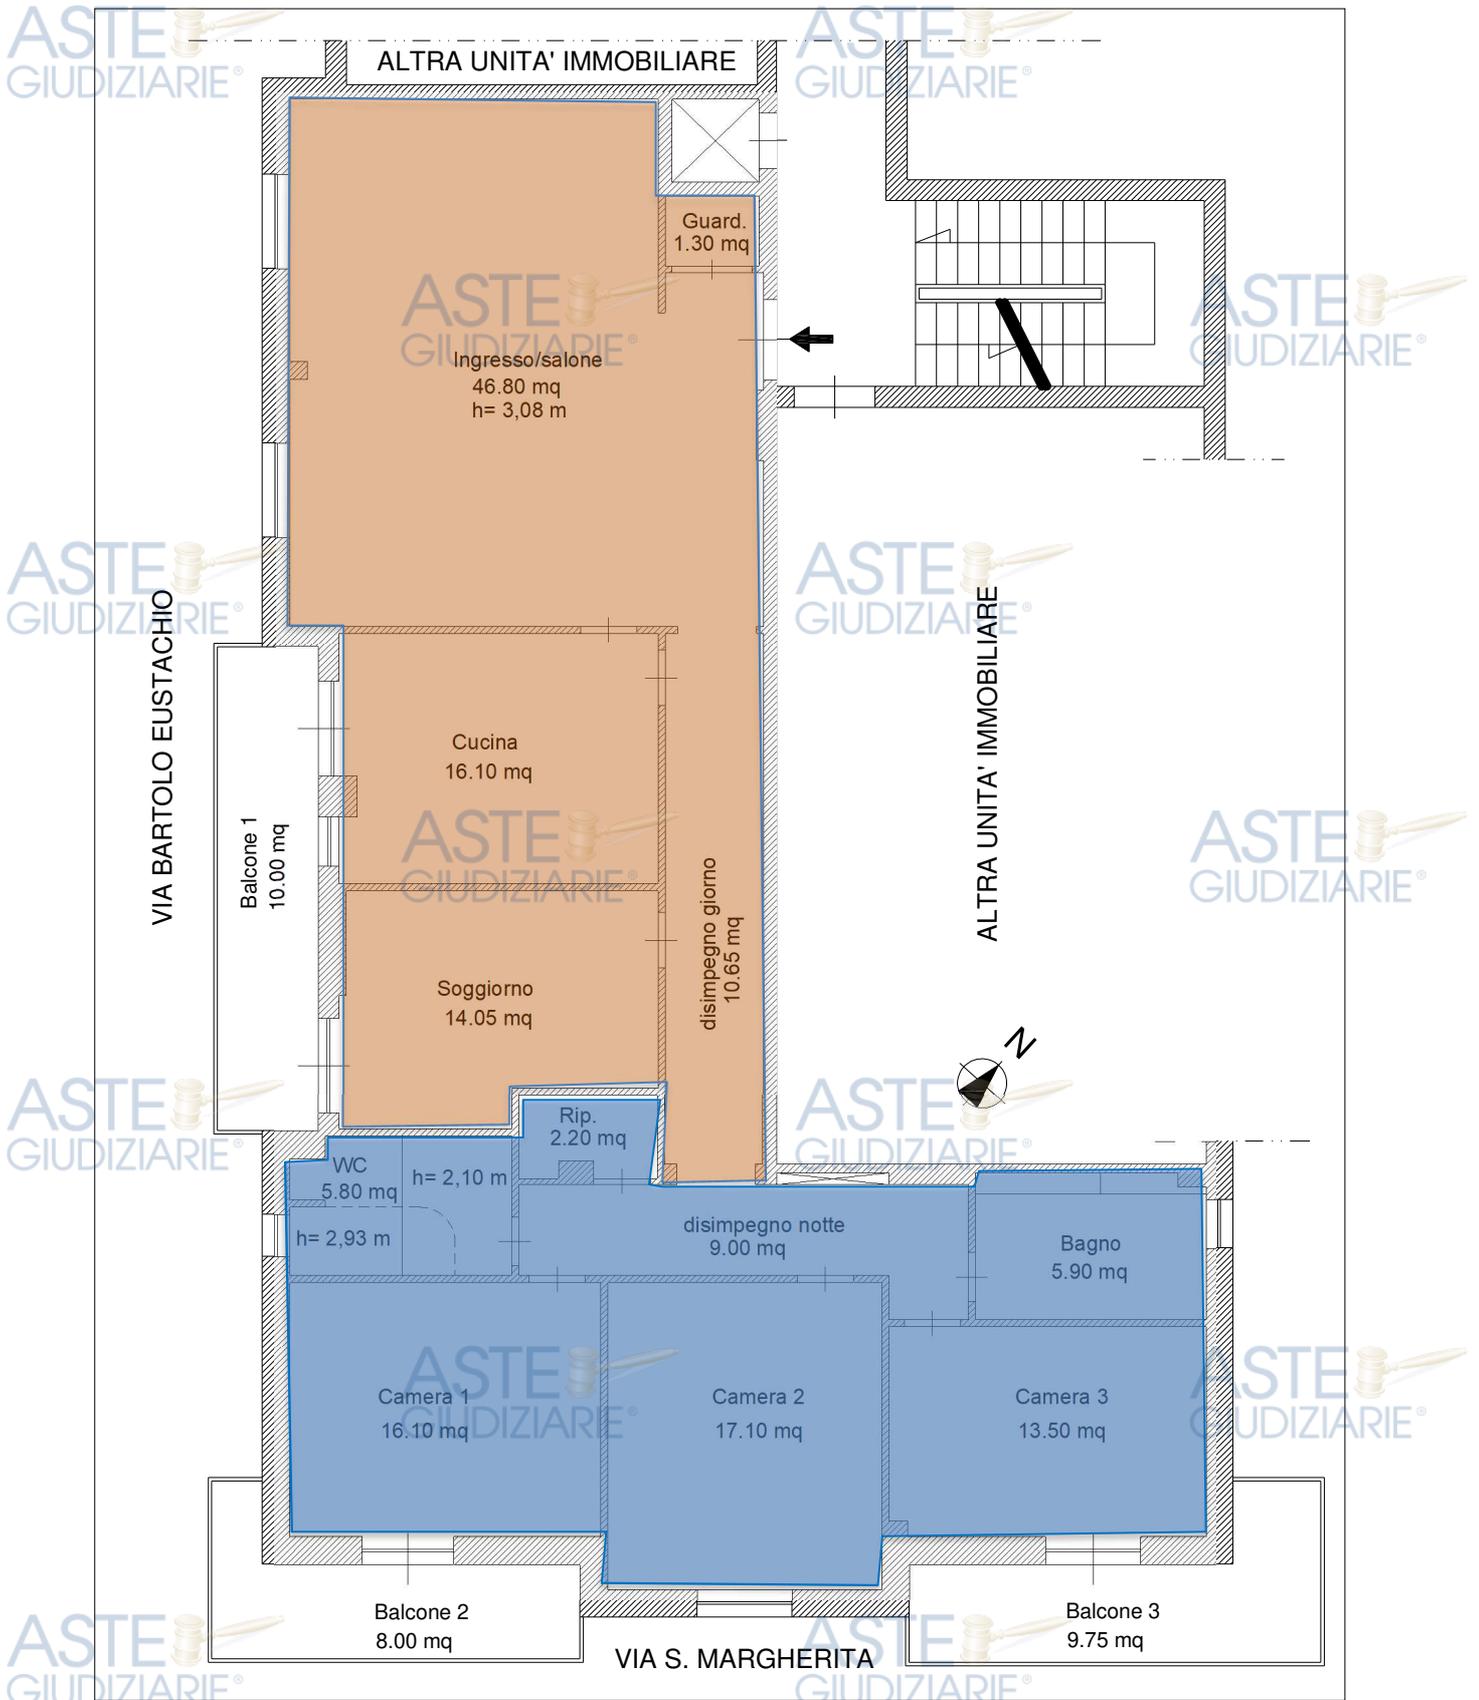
Pianta dell'abitazione pignorata – piano terzo, interno 11
